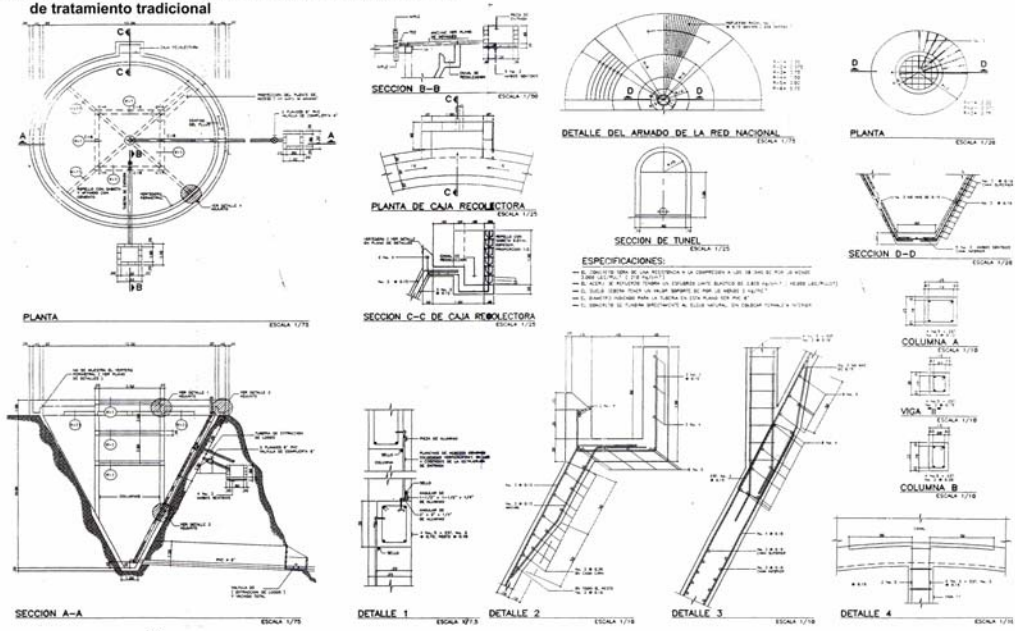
Plano de los filtros precaladores de la planta de tratamiento tradicional
